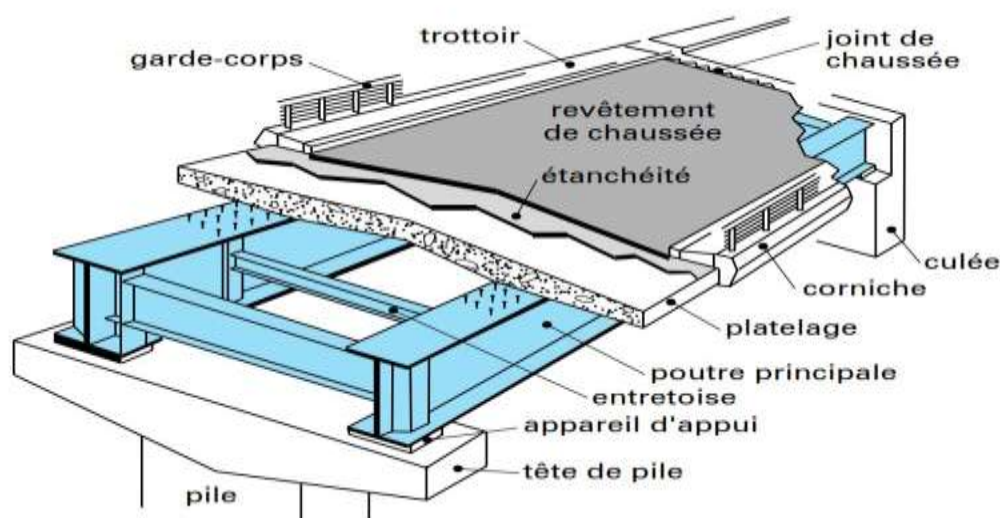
Eléments constitutifs d'un pont mixte bipoutres acier-béton
